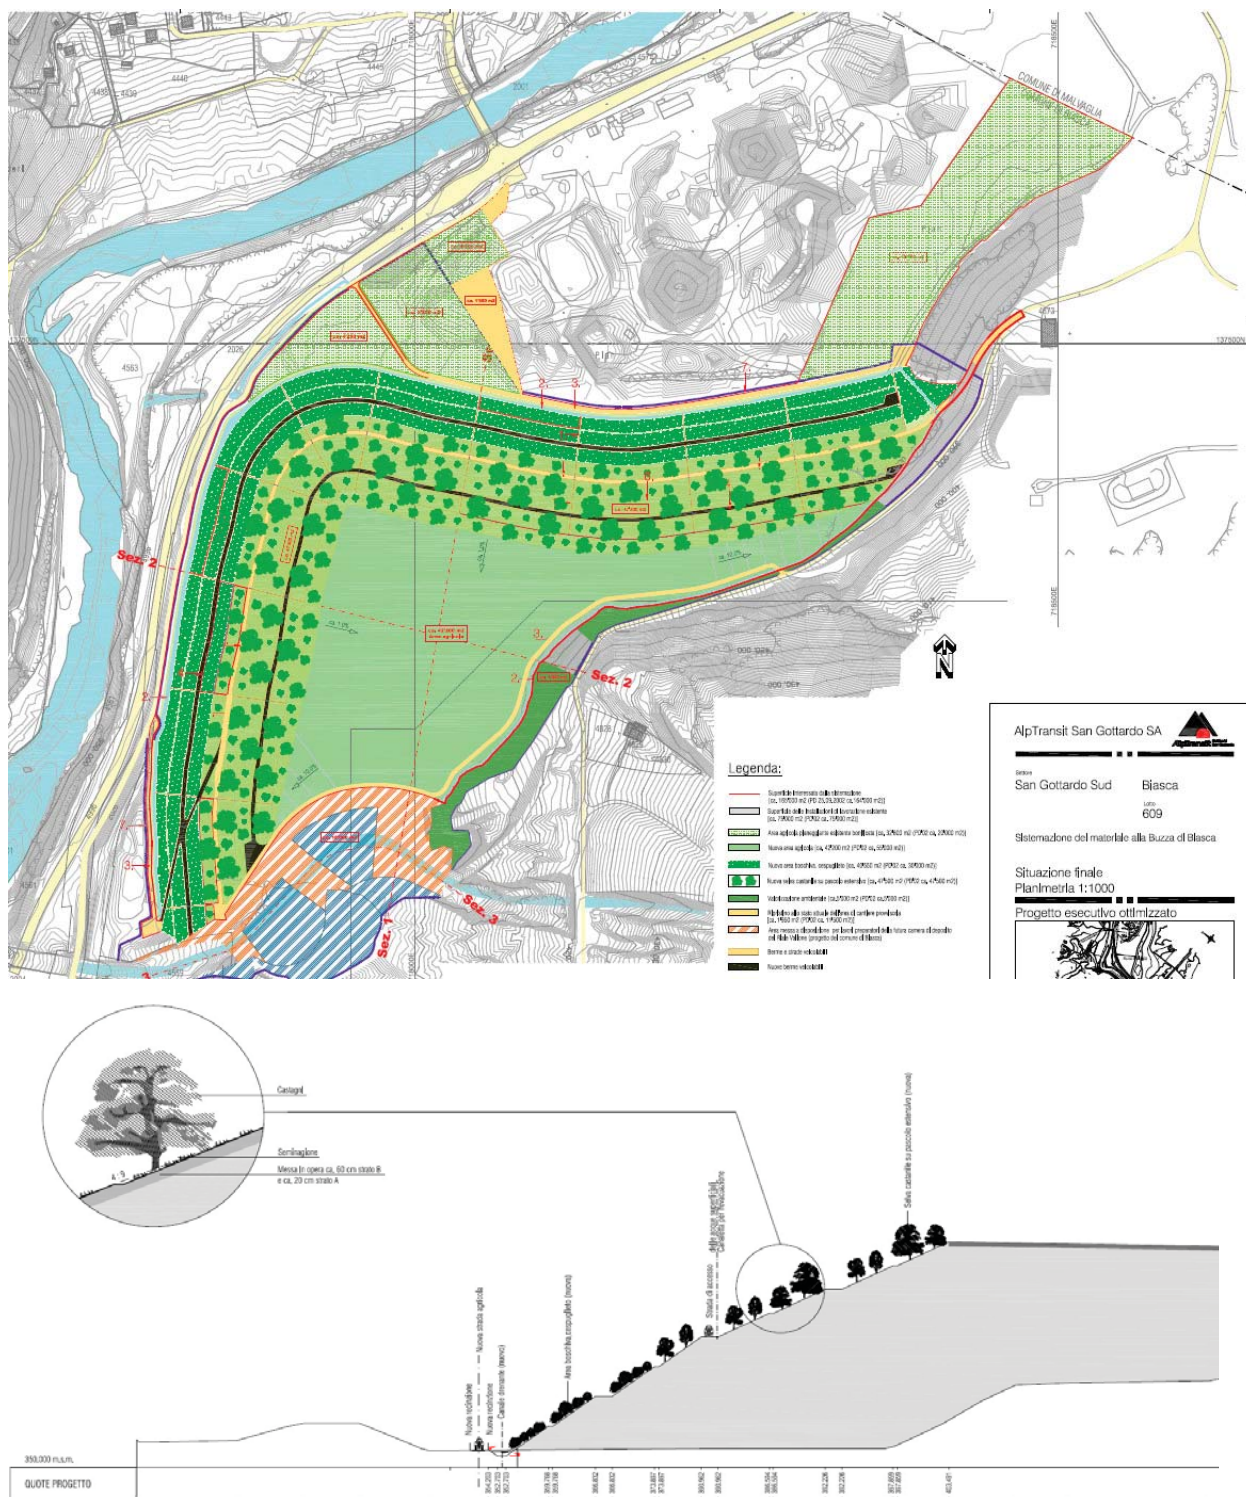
Sistemazione finale deposito ATG, pianta e sezione – rif. doc: 990/L609-203 e 203
